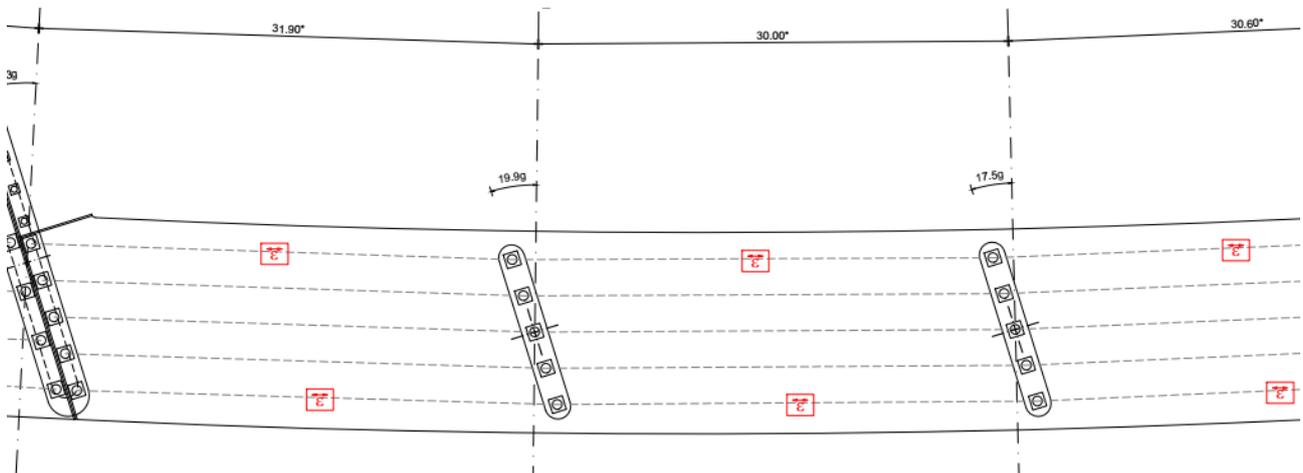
Ubicazione sensori su impalcato sezione a 5 travi (Pianta viadotto Collestrada)
